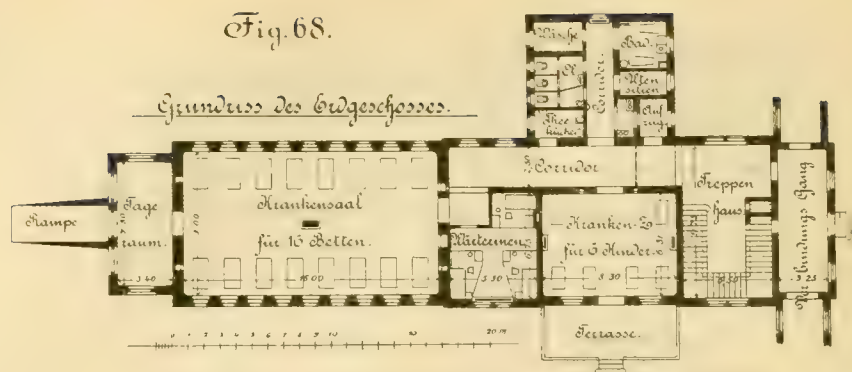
Billroth-Pavillon im Rudolfiner Haus zu Wien.
